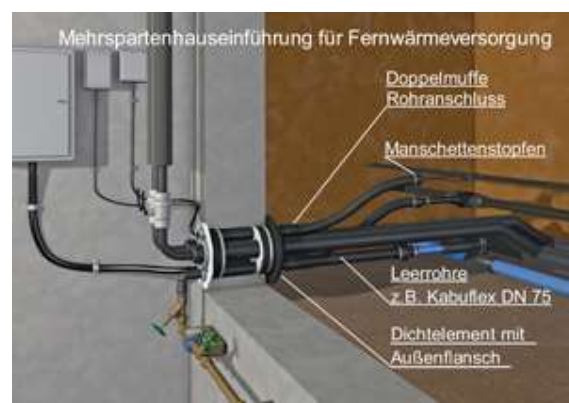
Mehrspartenhauseinführung mit Leerrohrtrasse
